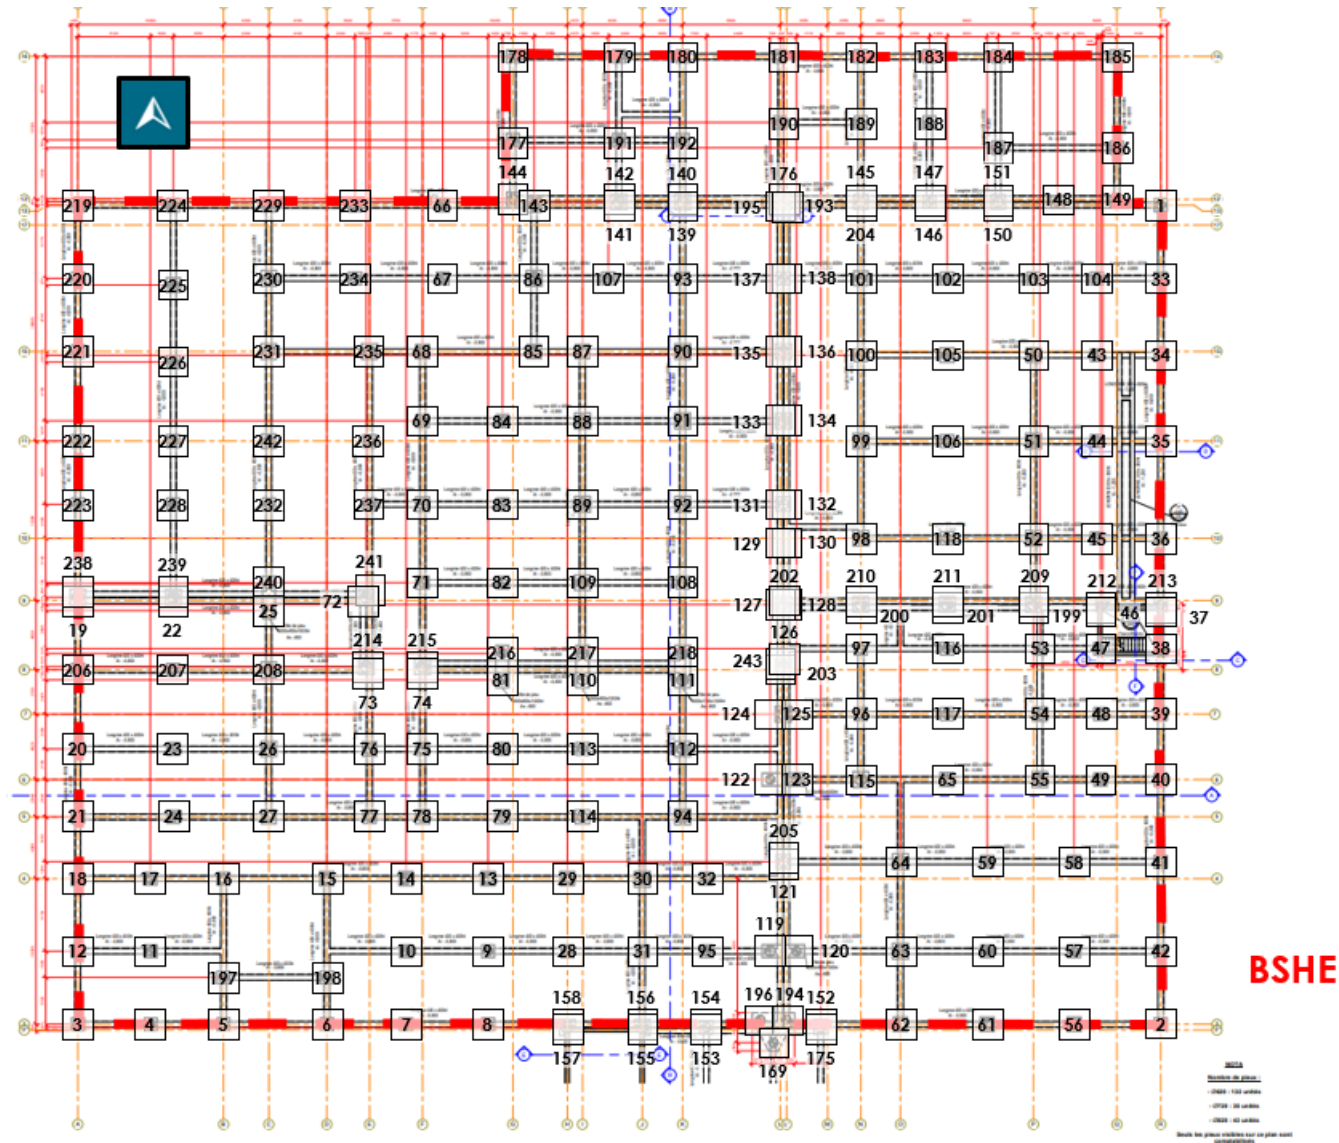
Plan de fondation du BSHE avec numérotation des pieux – CEA – Sans échelle
